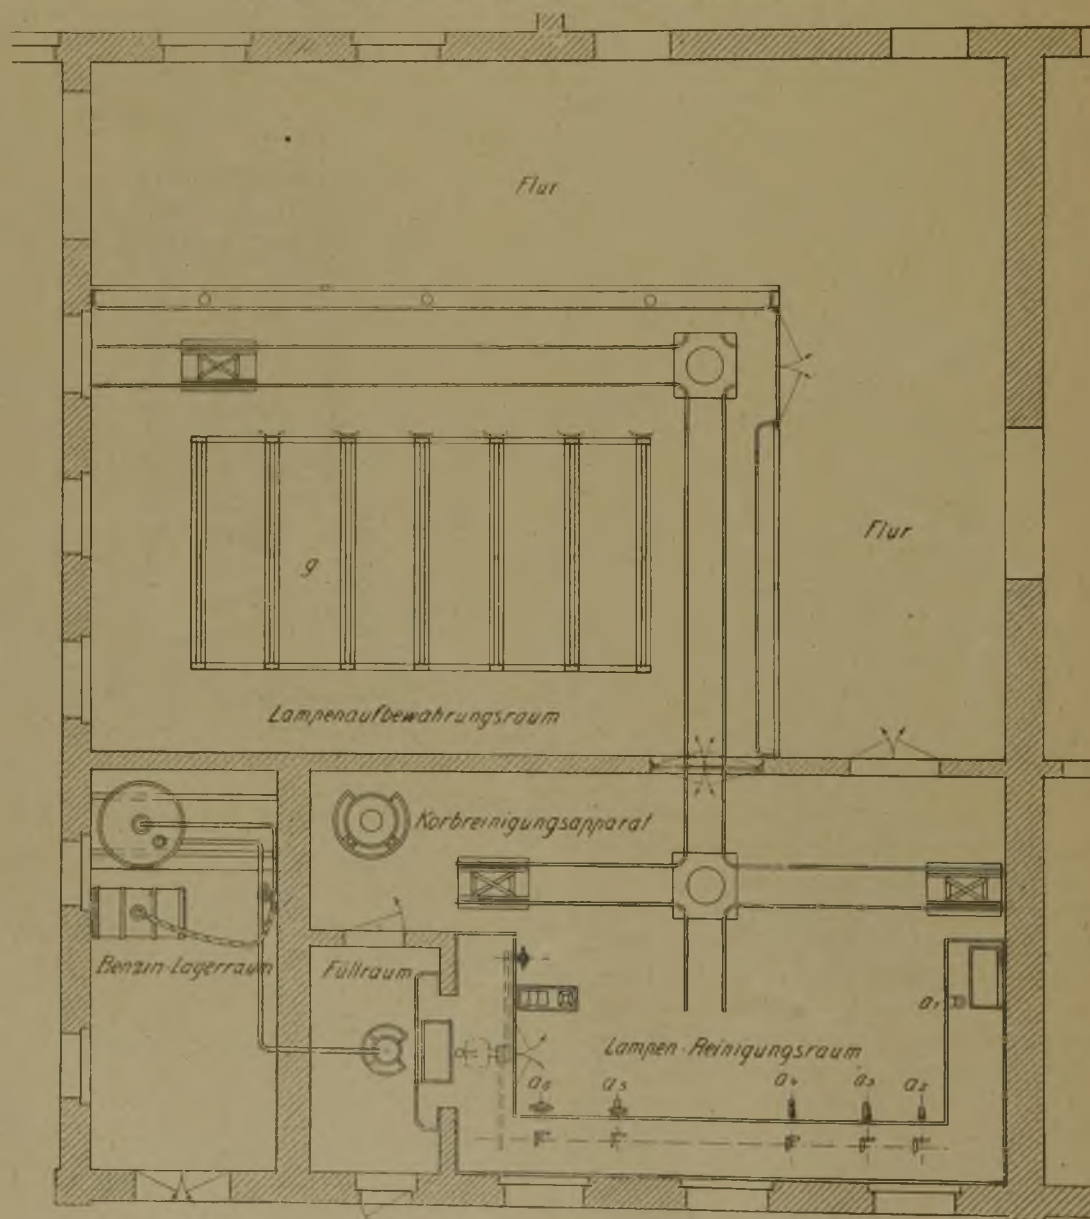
Lampenkaue nach Grüner & Grimberg.
